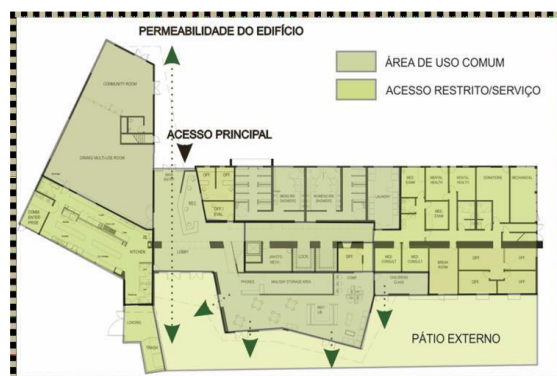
Planta Primeiro Pavimento Centro CAPSLO.
